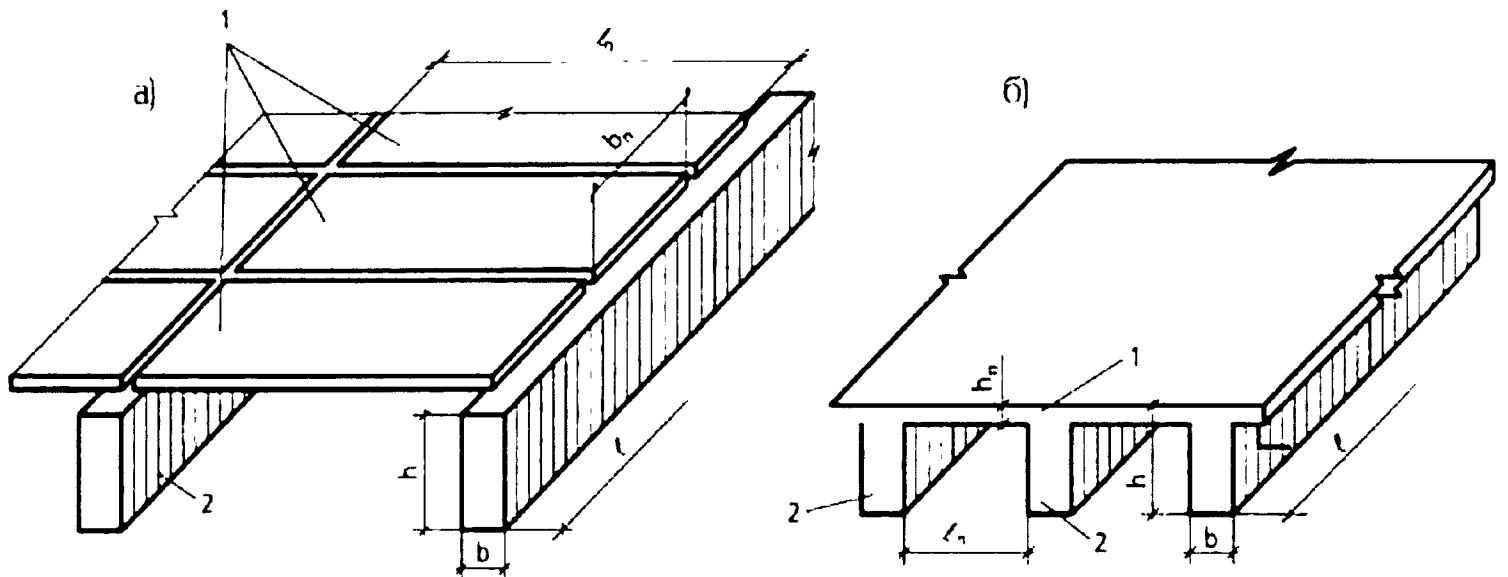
Схемы перекрытий из железобетонных изгибаемых элементов: а - сборное; б - монолитное; 1 - плиты, 2 - балки
